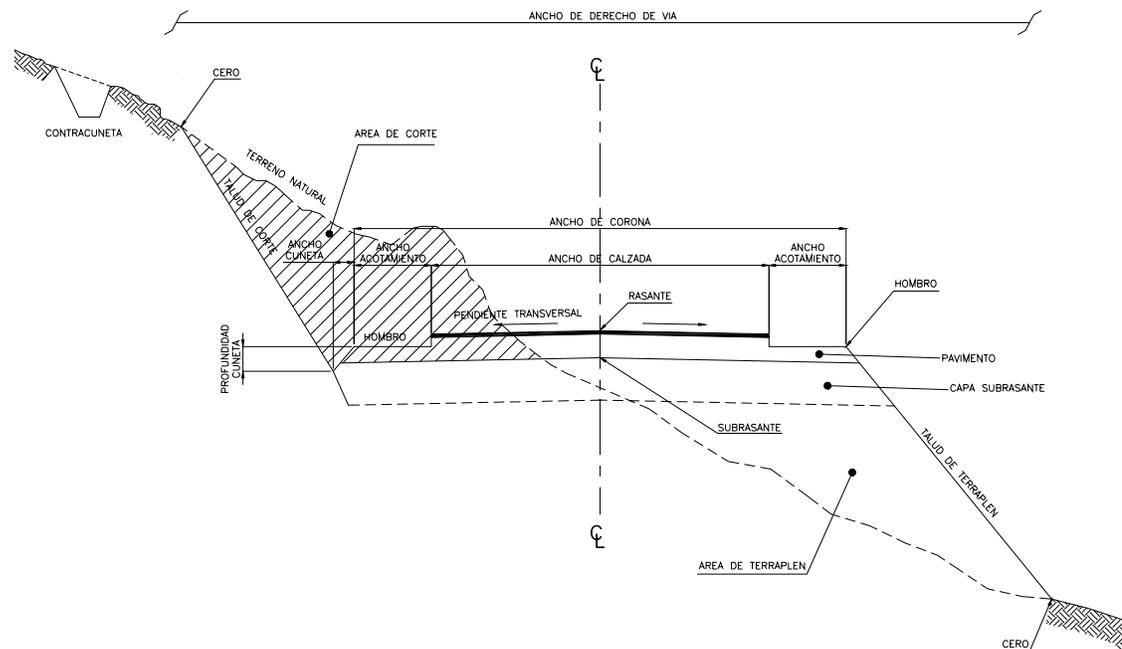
Sección Transversal Típica en una Tangente del Alineamiento Horizontal
